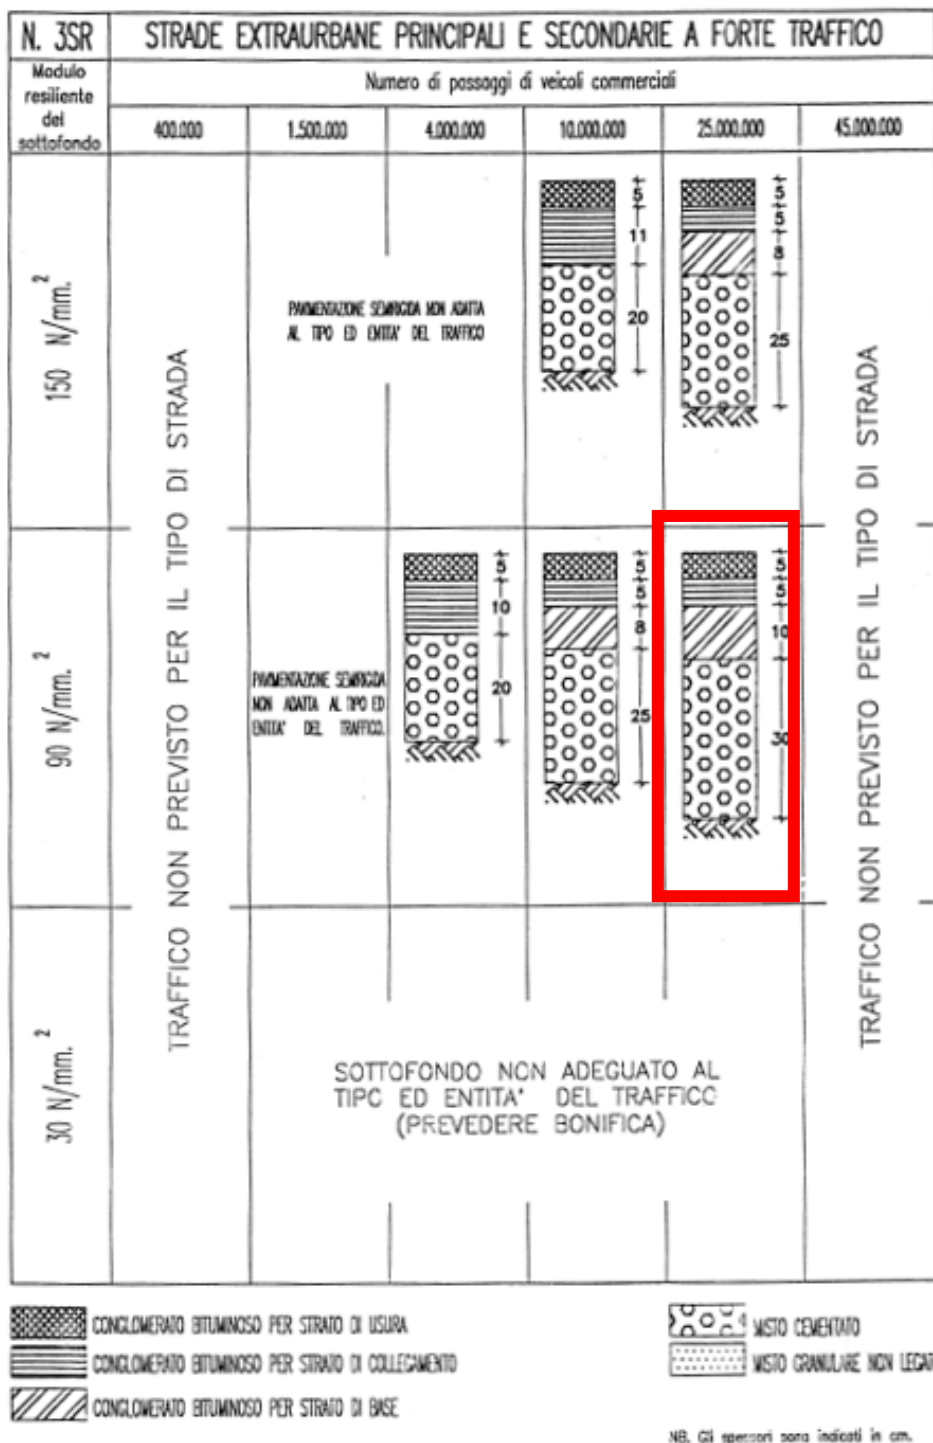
Pacchetto di pavimentazione da catalogo CNR
